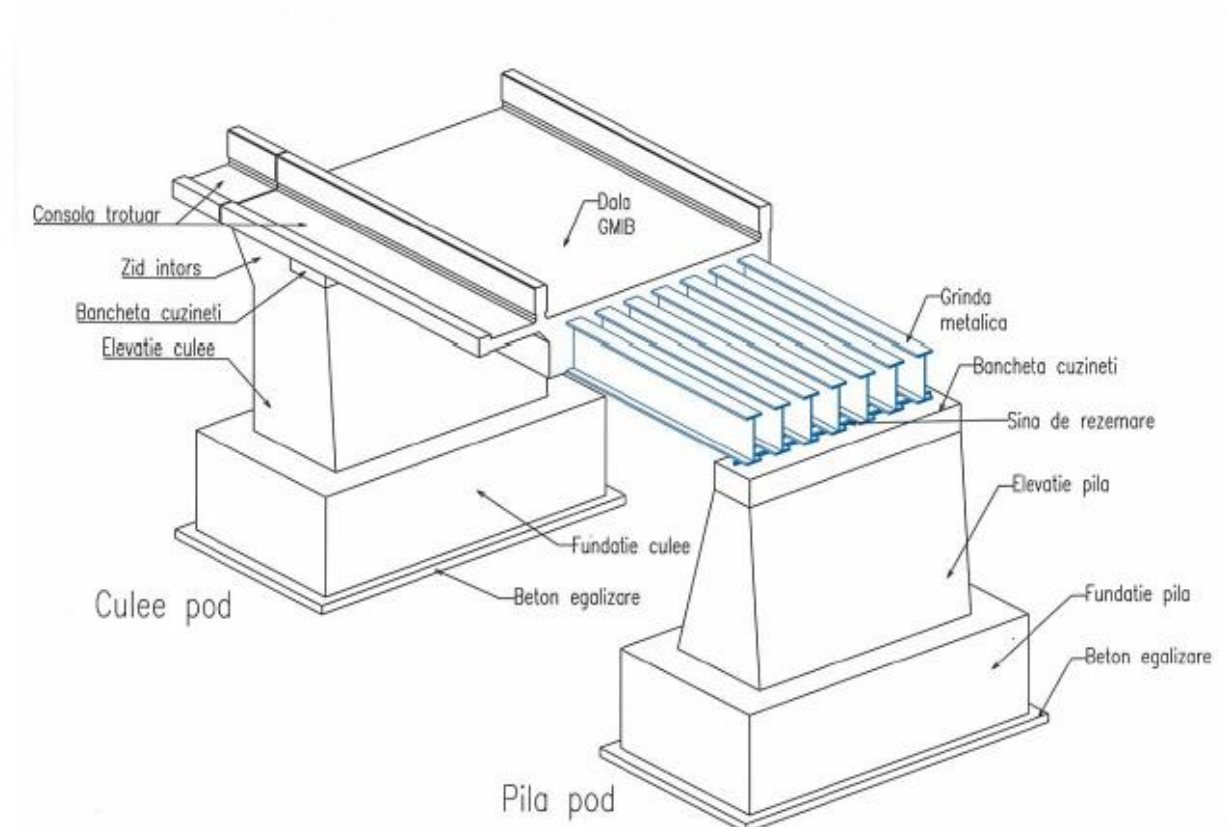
Elemente constructive ale unui pod structură mixtă oțel-beton tip grinzi înglobate [2]
